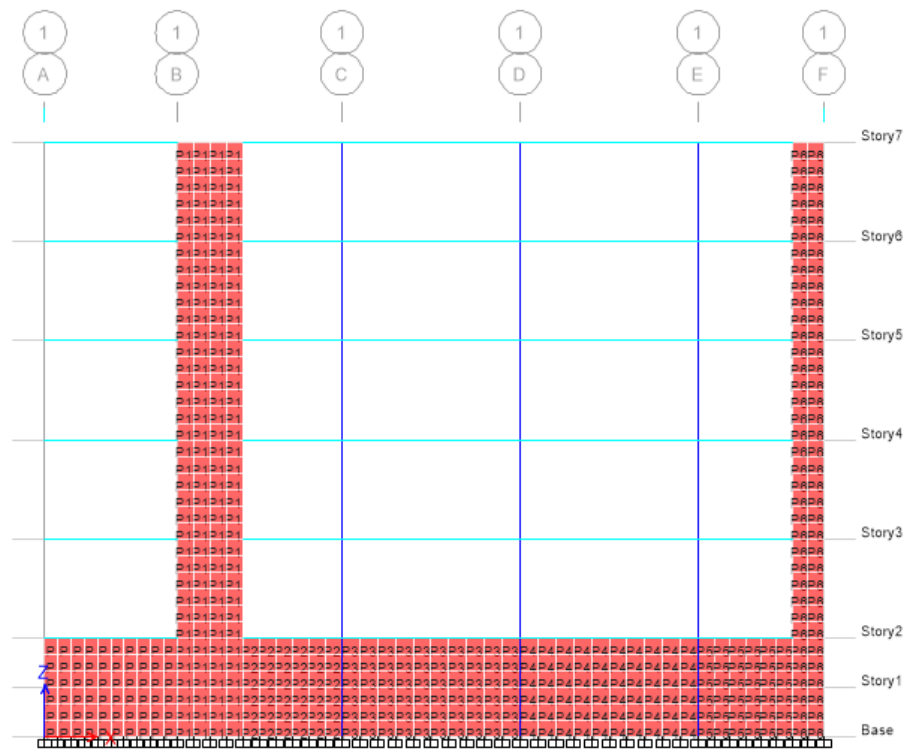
A: Vista elevación eje 1 del modelo con Piers. Fuente: Elaboración propia.
